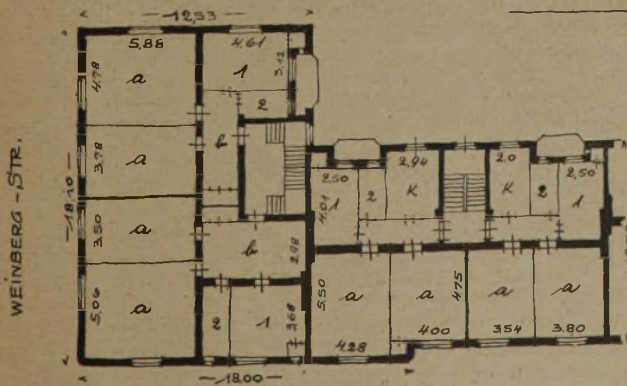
bis 24. Grundrisse zu Abb. 21. (1 : 400.)
